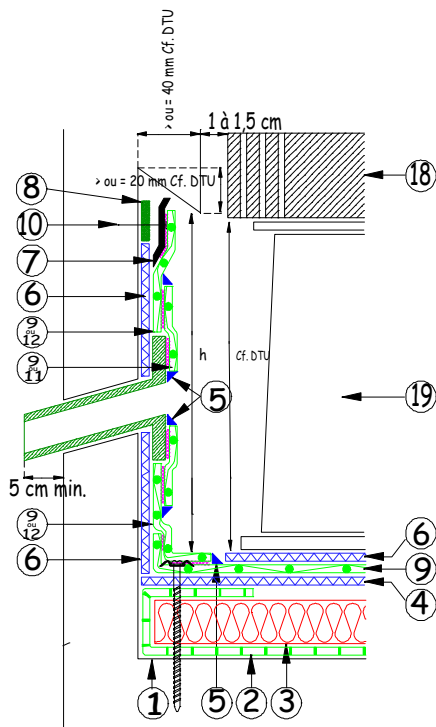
Relevé avec protection lourde par dalles sur plots - Trop plein
